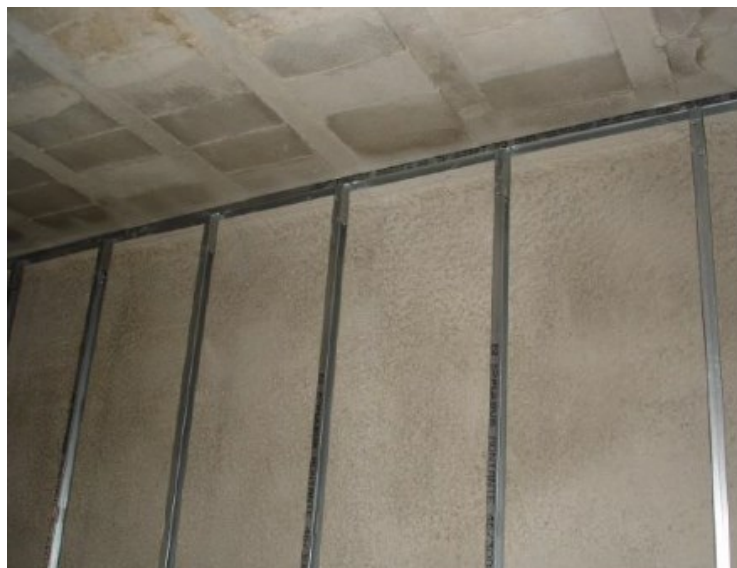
Sistema de tabiques metálicos para a construção das paredes interiores - Fonte: Porto Vivo, SRU
